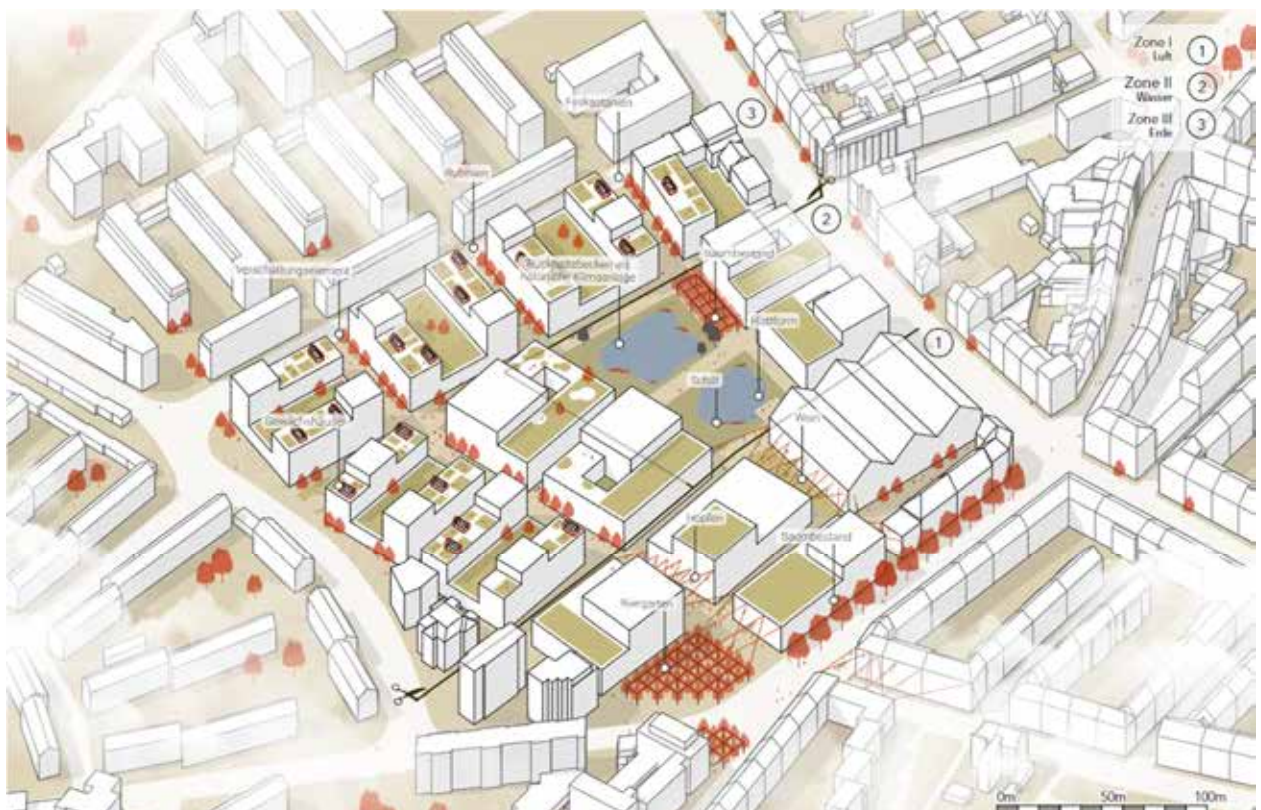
Axonometrie landwirtschaftliche Produktion innerhalb eines bebauten Quartiers durch Indoorfarming, Dachgärten, Fassaden- und Straßenbegrünung, etc. Ausschnitt aus dem Entwurf „Marktstraße +“ von Julia Krings (FH Aachen)
